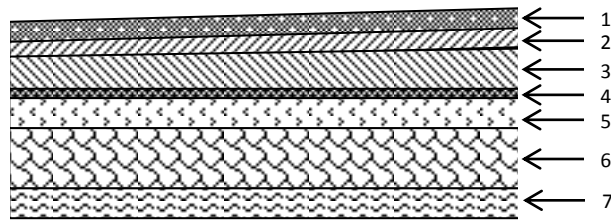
Coupe transversale du plancher terrasse inaccessible
